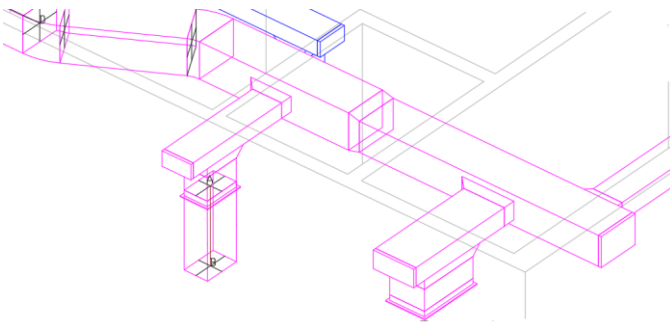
Vista general instalación HVAC, plano en 3D más detallada
